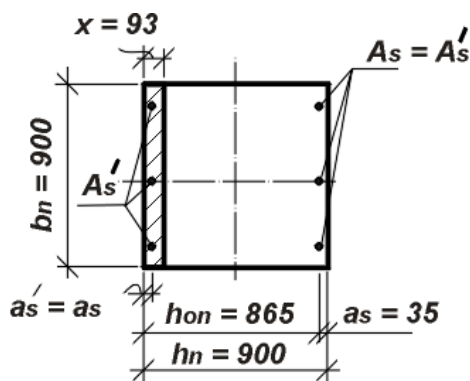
К расчету продольной арматуры подколонника по сечению II-II
